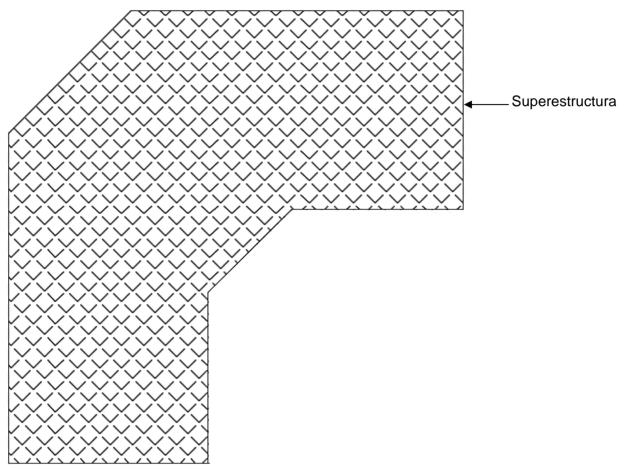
Esquema estructural de la superestructura del proyecto. Elaboración propia.
